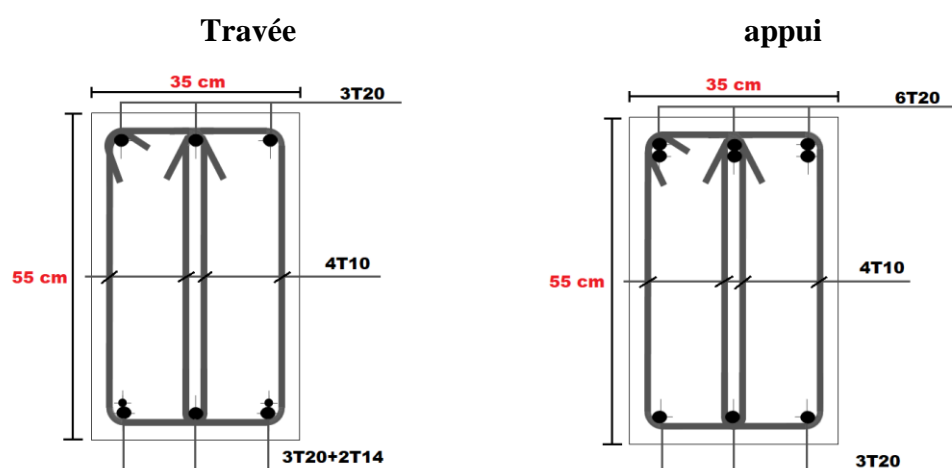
ferrailage des poutres principales 35×55(RDC-8^{ème} étage).
